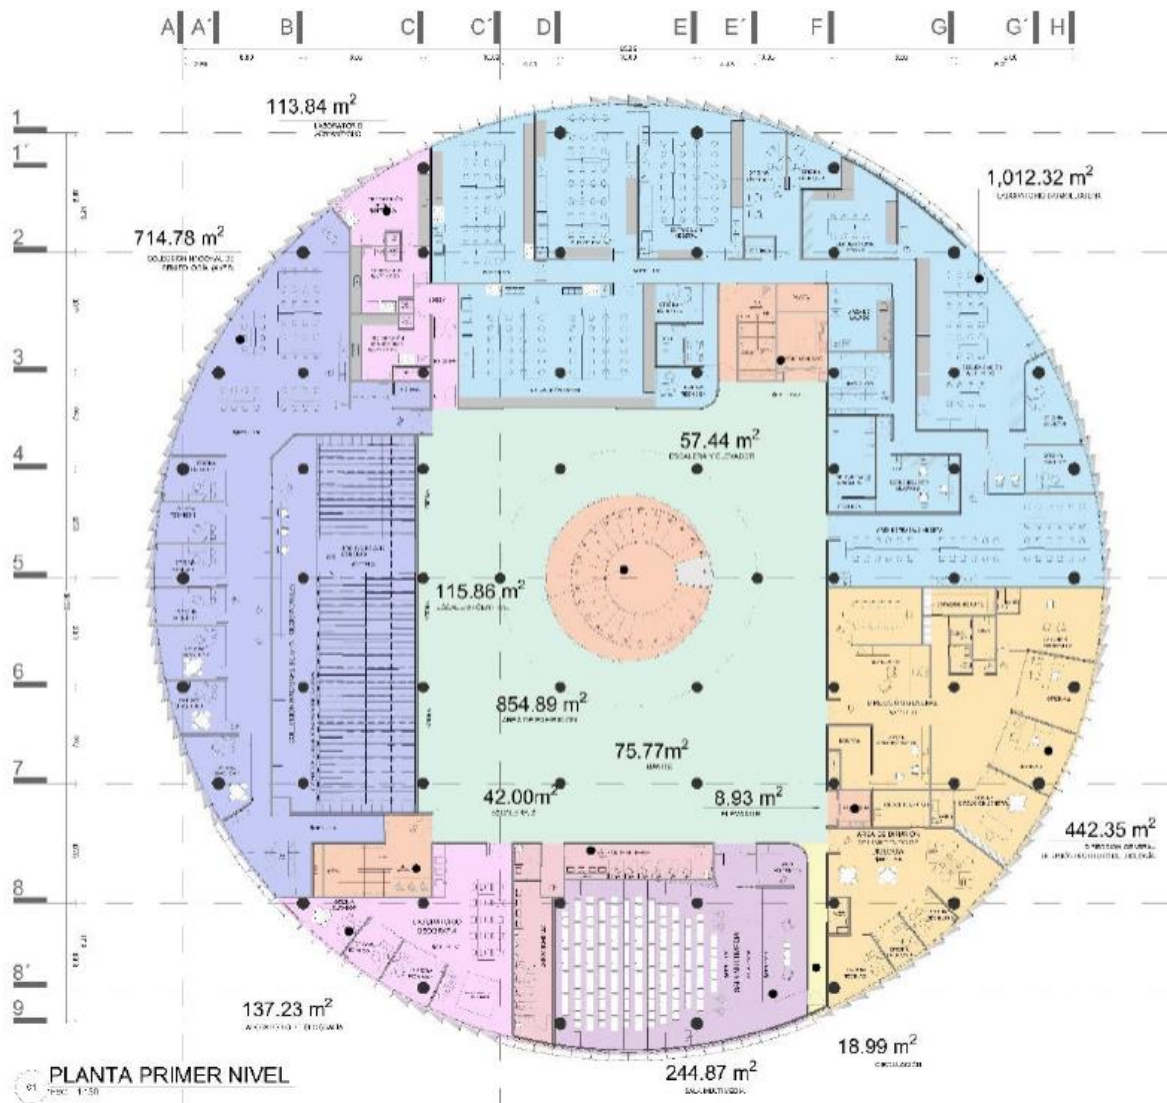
Planta arquitectónica nivel primer nivel.
